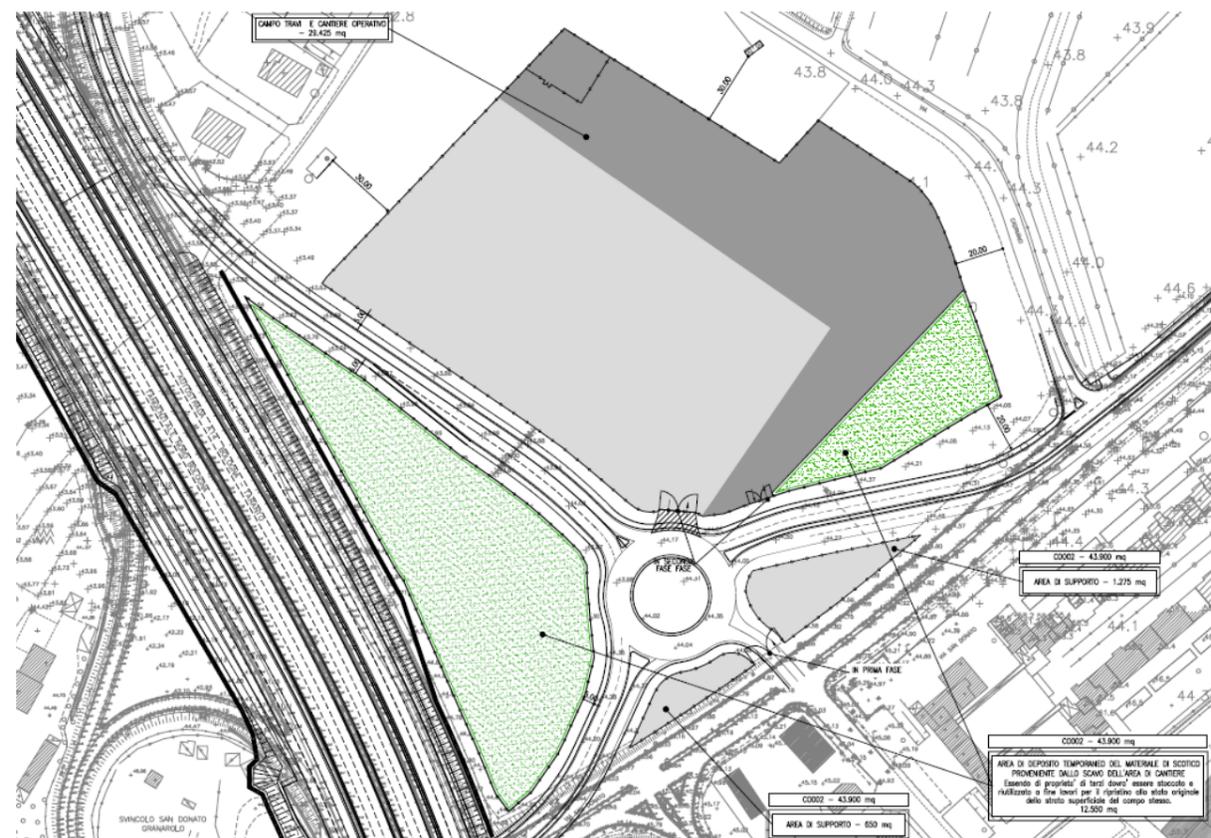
area di cantiere CO02 (estratto tav. CAP0310-0)
